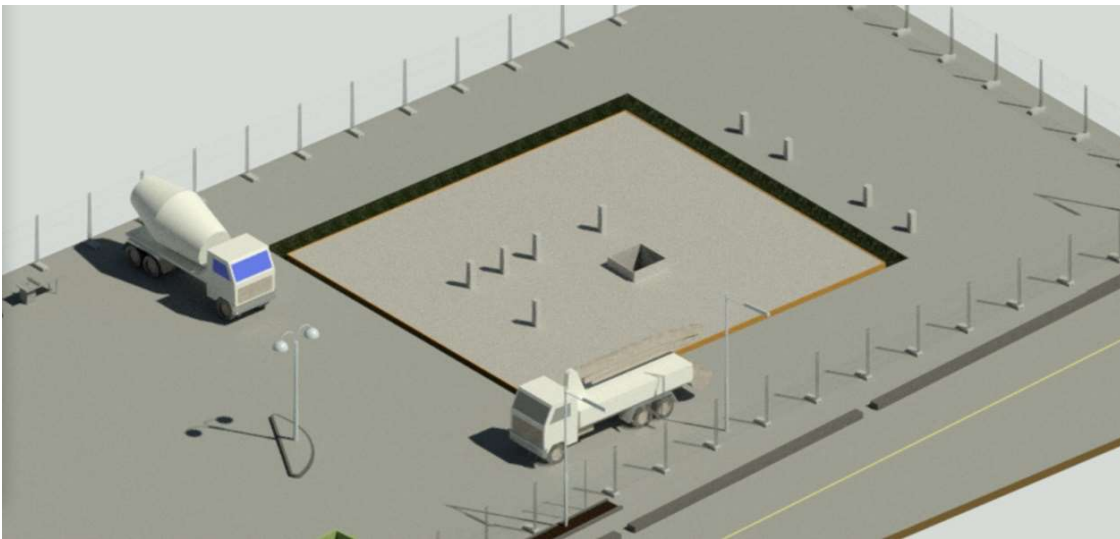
Area di scavo e getto della fondazione a platea.
